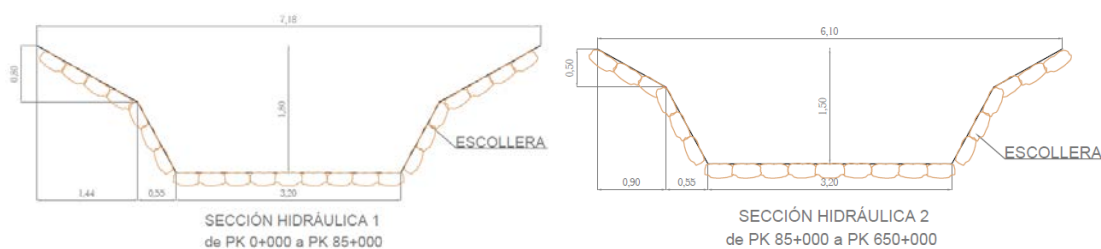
Secciones hidráulicas del encauzamiento tipo del encauzamiento.
